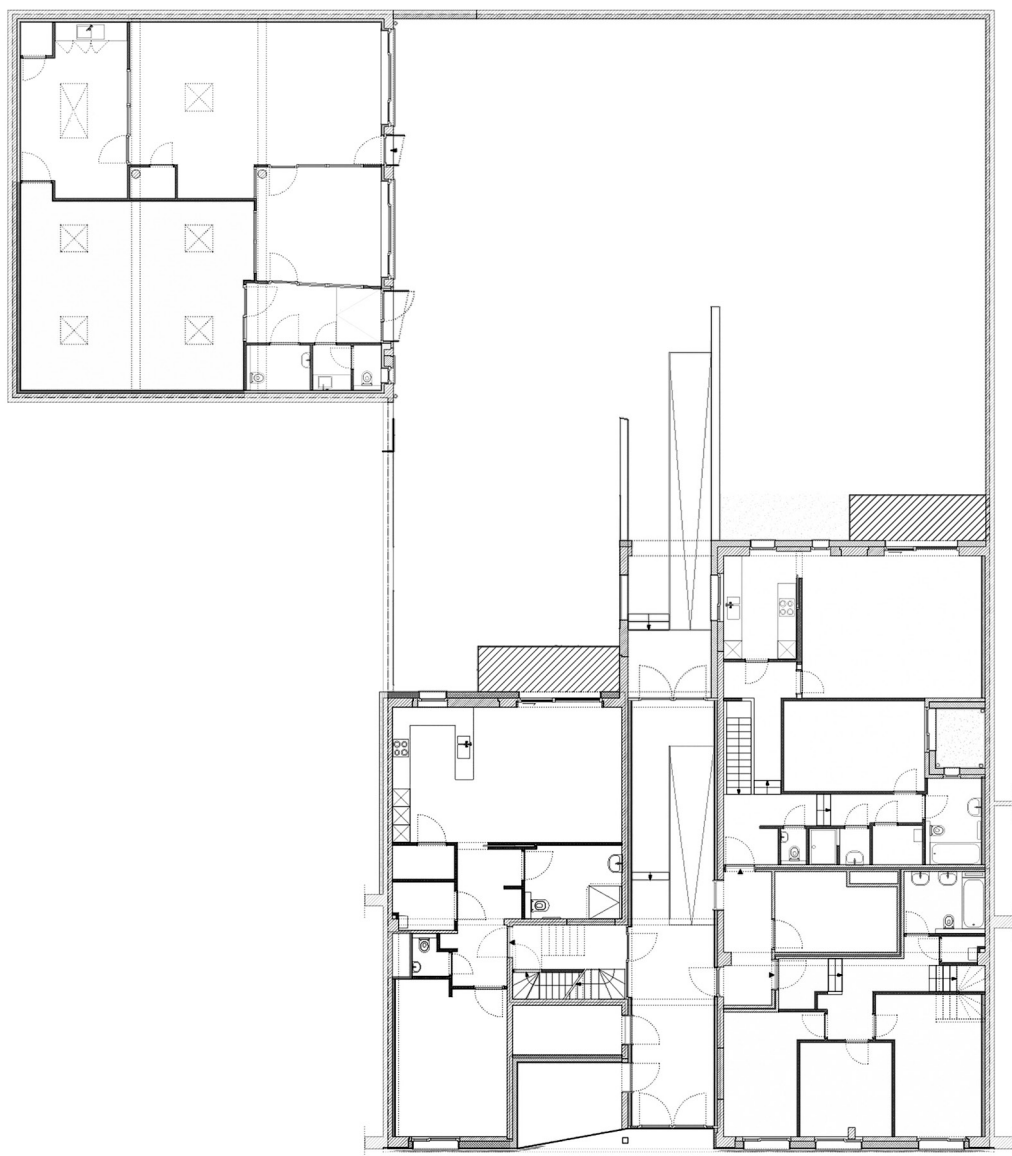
Pianta del piano terra del progetto Le Nid. Progetto: LOW-A. Disegno: gentile concessione dello Studio LOW-A, modificato dall'autore.
